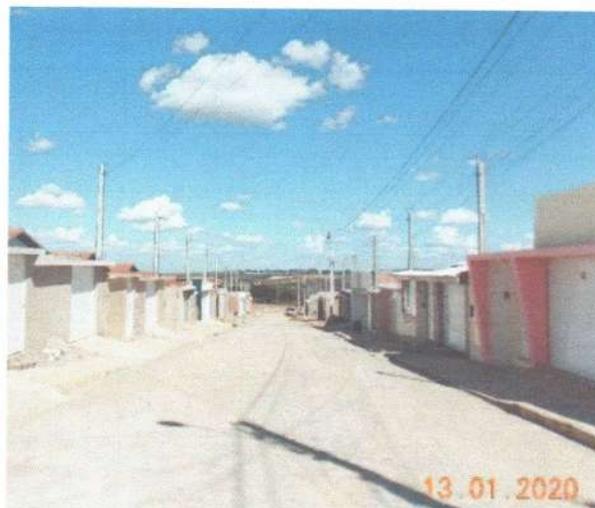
Visão geral do padrão construtivo no Residencial Antônio Cordeiro.
